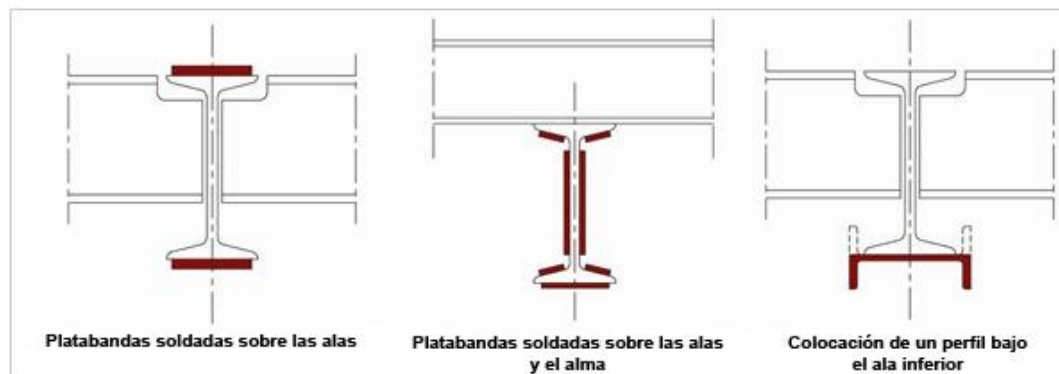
Refuerzo de perfiles I con platinas soldadas en patines y alma.
